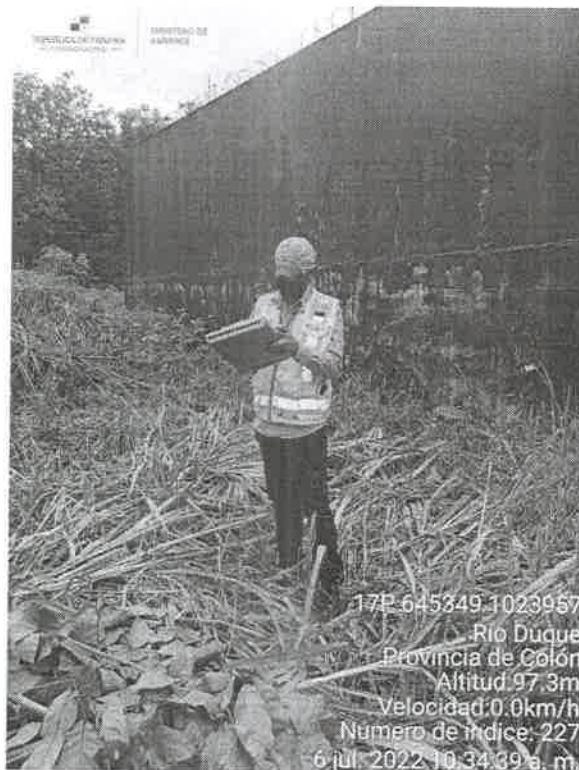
Parte lateral del terreno que colinda con un muro de la empresa EcoKlean.
